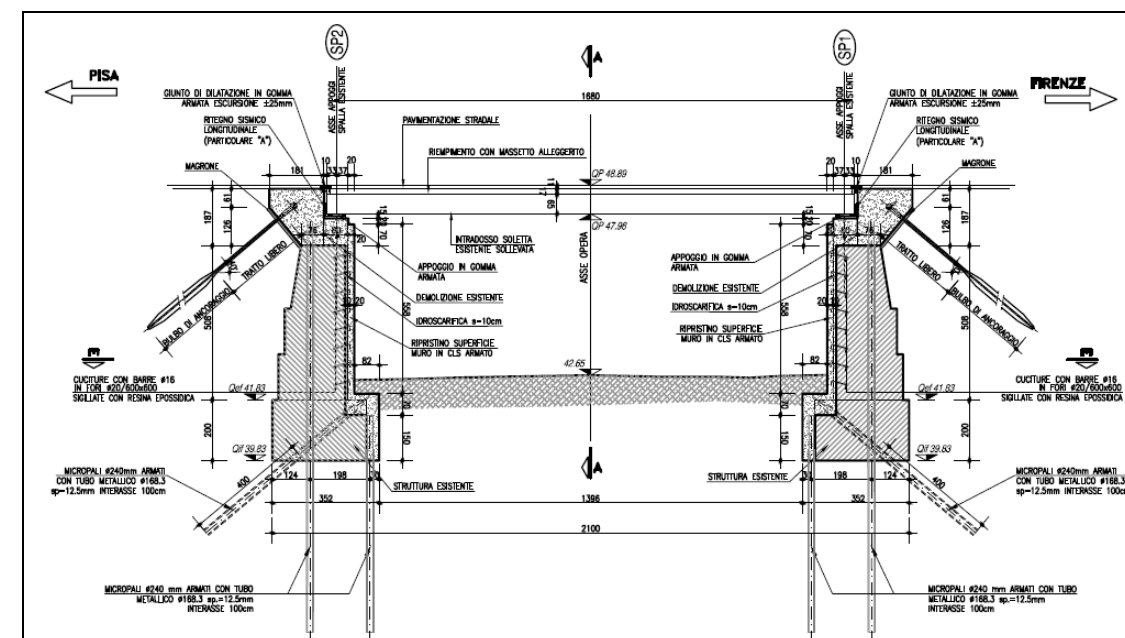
Sottovia nuovo PRG. Sezione longitudinale
